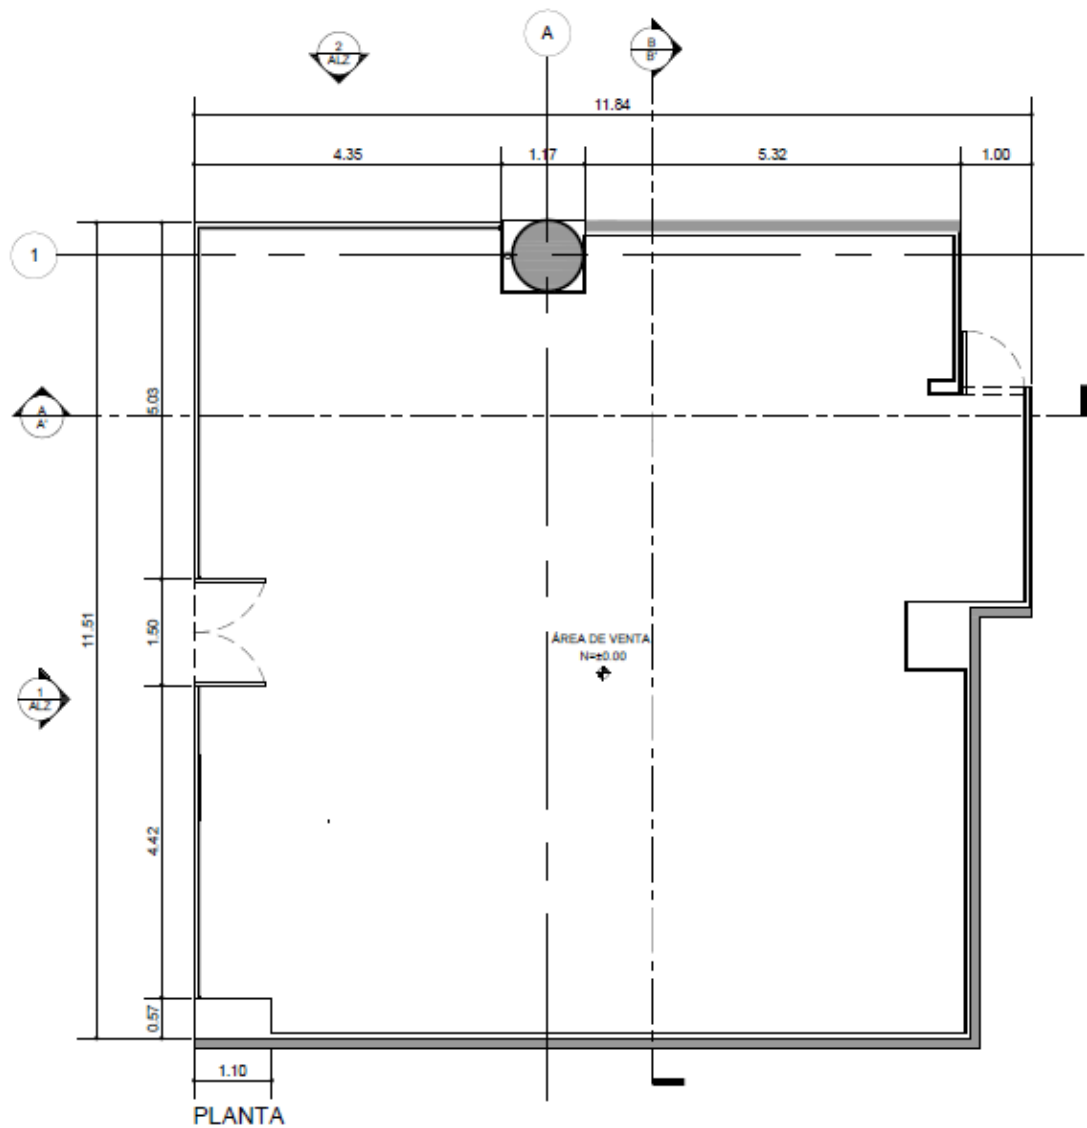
Planta arquitectónica del local. Área de Venta. (Ares Diseño, 2009)
